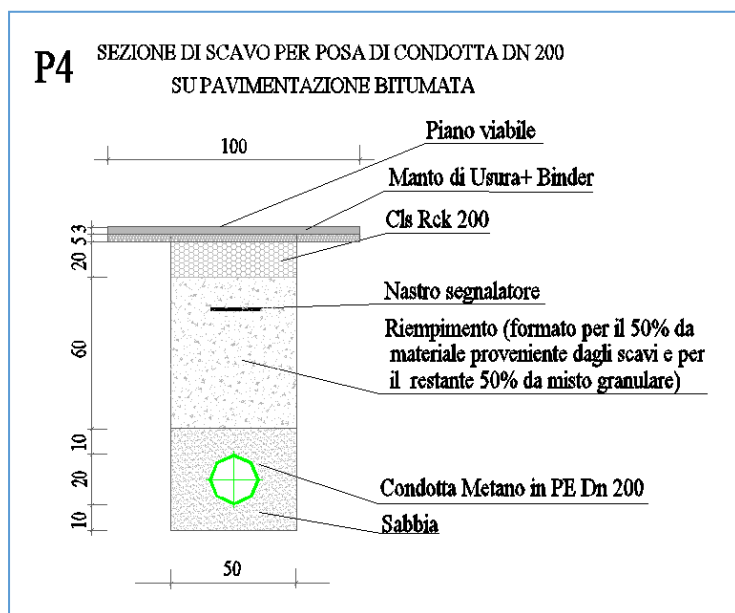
Sezione di scavo per posa condotta su pavimentazione bitumata
